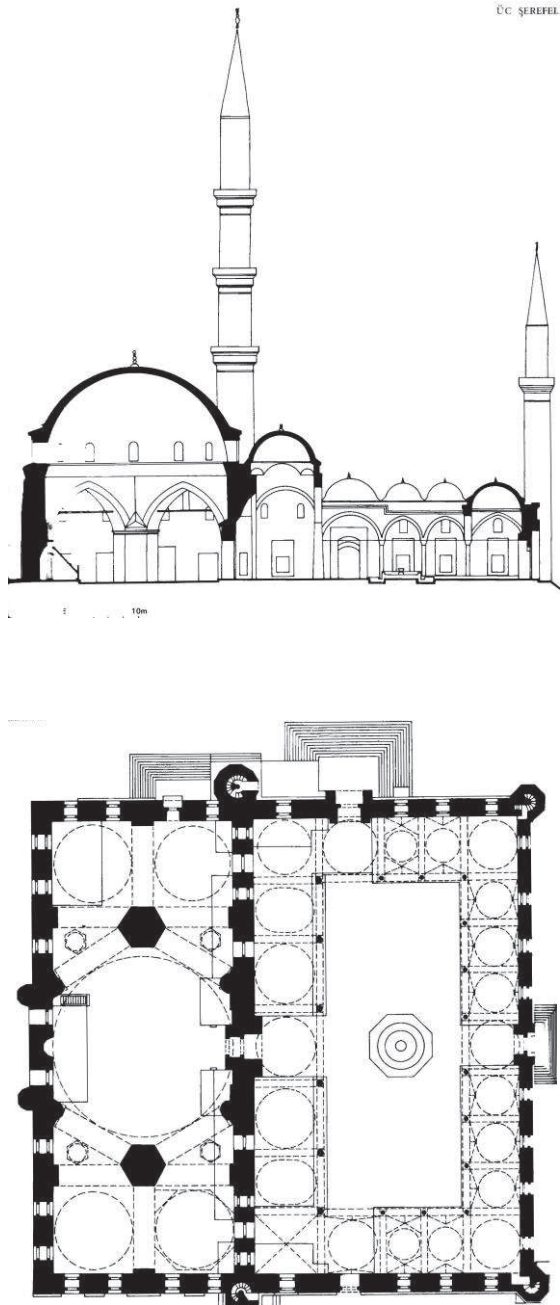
Uç Serefeli. Planta y sección longitudinal. (Planta dibujo del autor).
